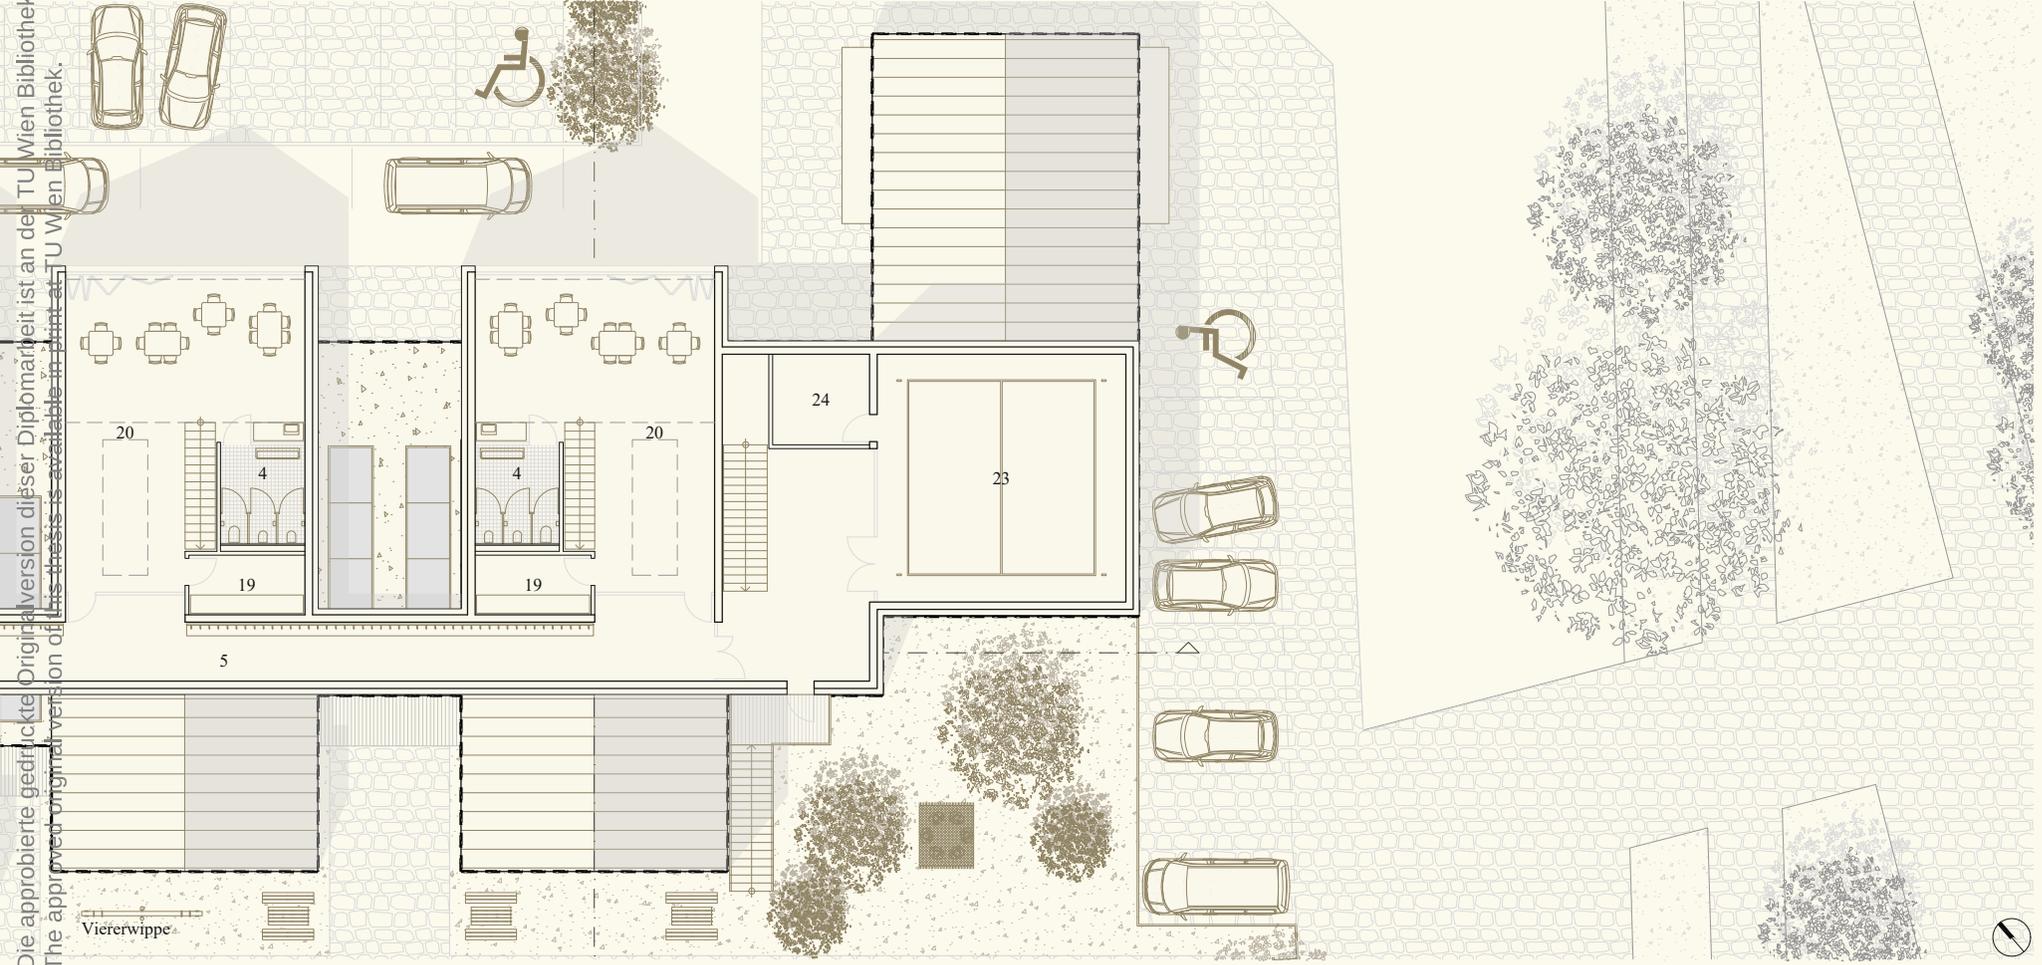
, Grundriss Obergeschoss | 1:250
